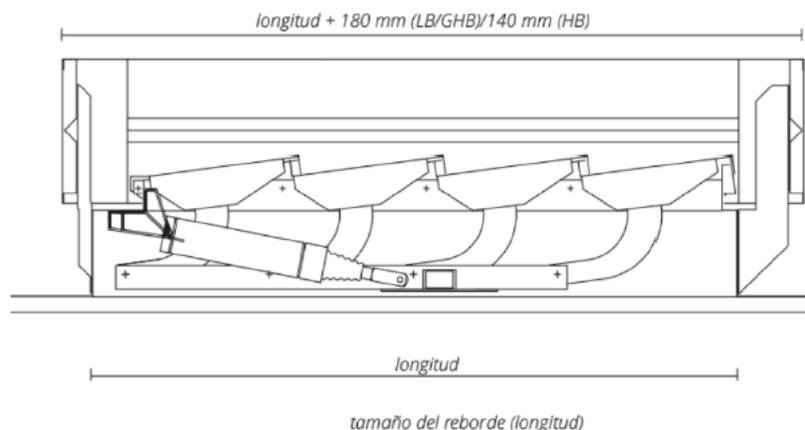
Vista de la sección longitudinal del exutorio de lamas EURA.
